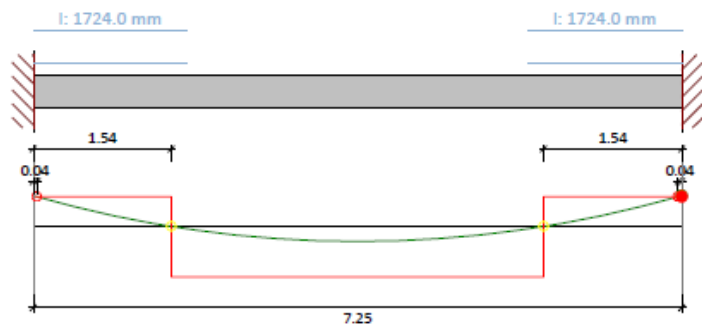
Reforzamiento en vigas FRP a flexión, Fuente: Propia
